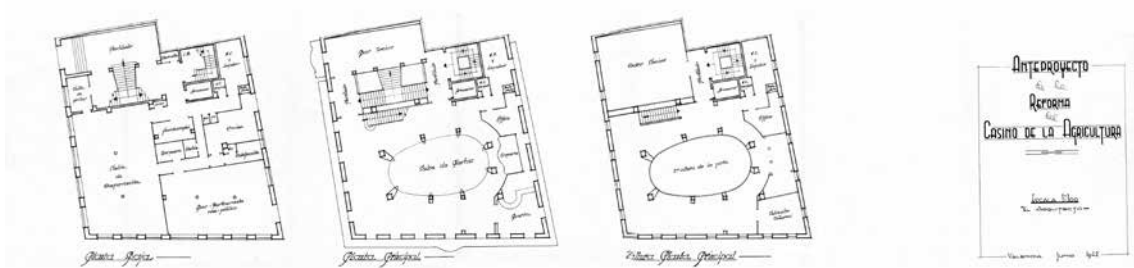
Propuesta para la nueva sede de la *Real Sociedad Valenciana de Agricultura y Deportes*, Arquitecto Antonio Gómez Davó. Plano de planta baja, planta principal y planta 2ª altura de la planta principal. E:1/100, junio de 1942. A.G.D.
